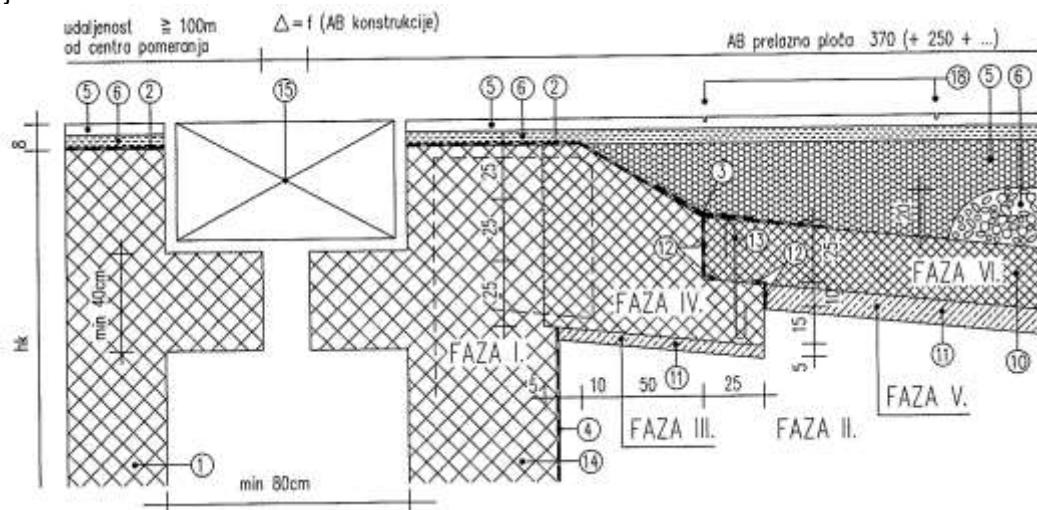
Detalj oslanjanja i vrha prelazne ploče kod grednih rasponskih AB konstrukcija kada je dužina rasponske konstrukcije do 150 m
